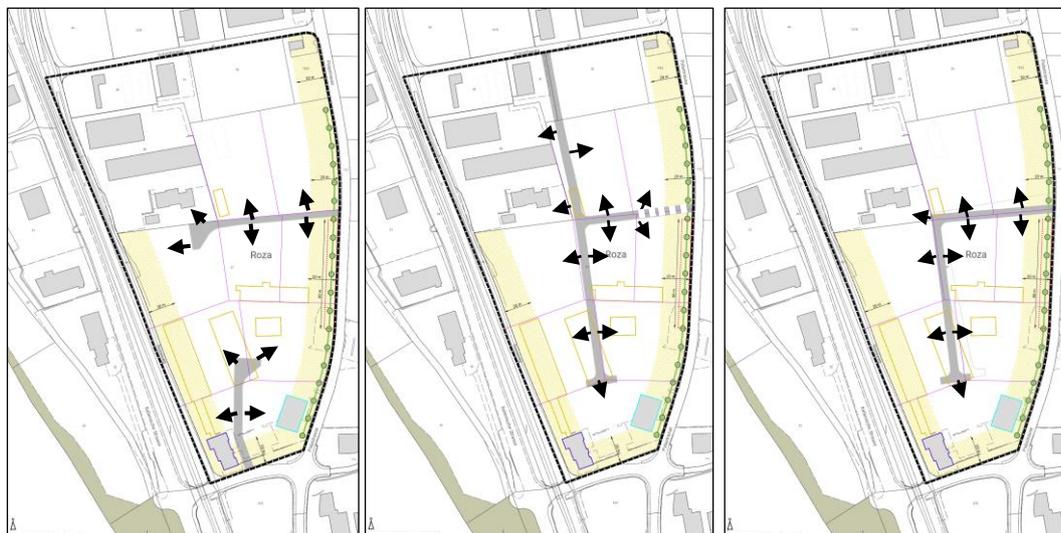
Schematische Darstellung möglicher geprüfter Erschliessungsvarianten zu einem frühen Stand der Planung (Darstellung R+K auf Basis Daten amtliche Vermessung, Stand 09.01.2023)
